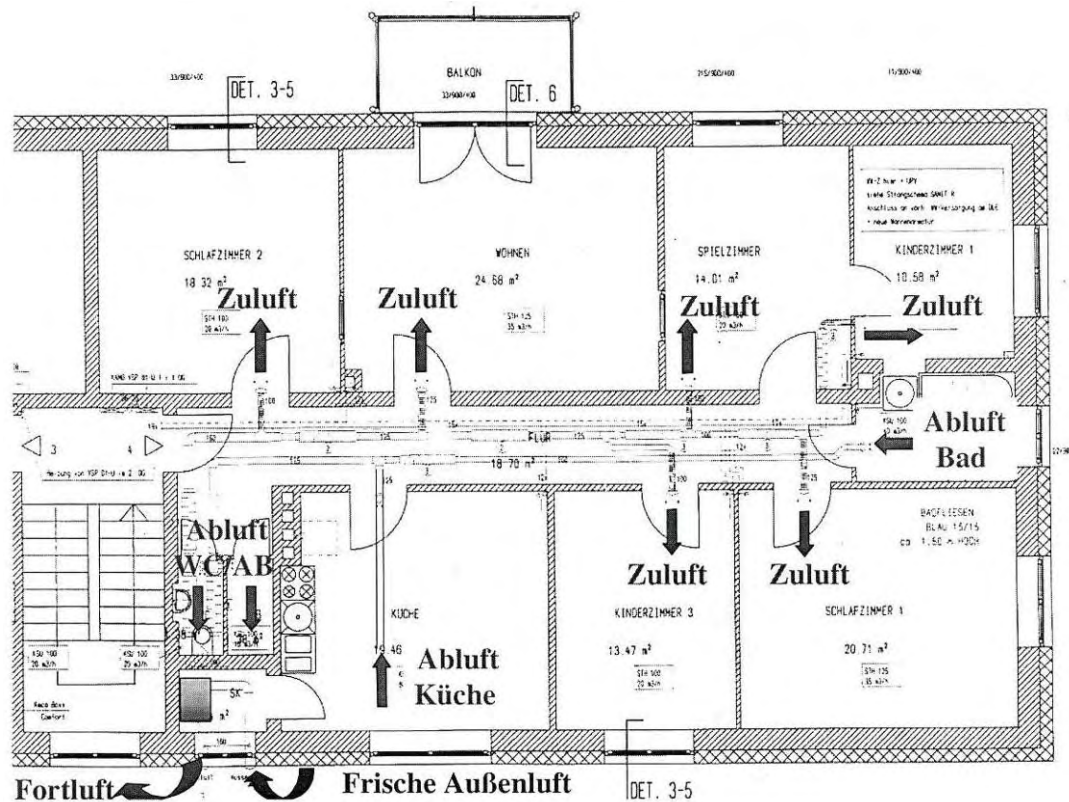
Anlagenkonzept (dezentral, wohnungsweise) im Grundriss
